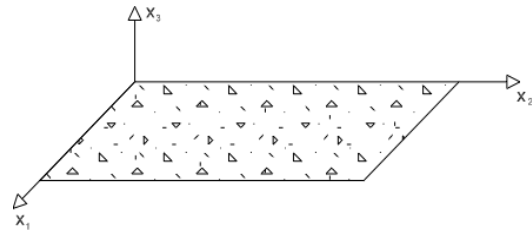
Plano m3dio da laje para o modelo de Kirchhoff
